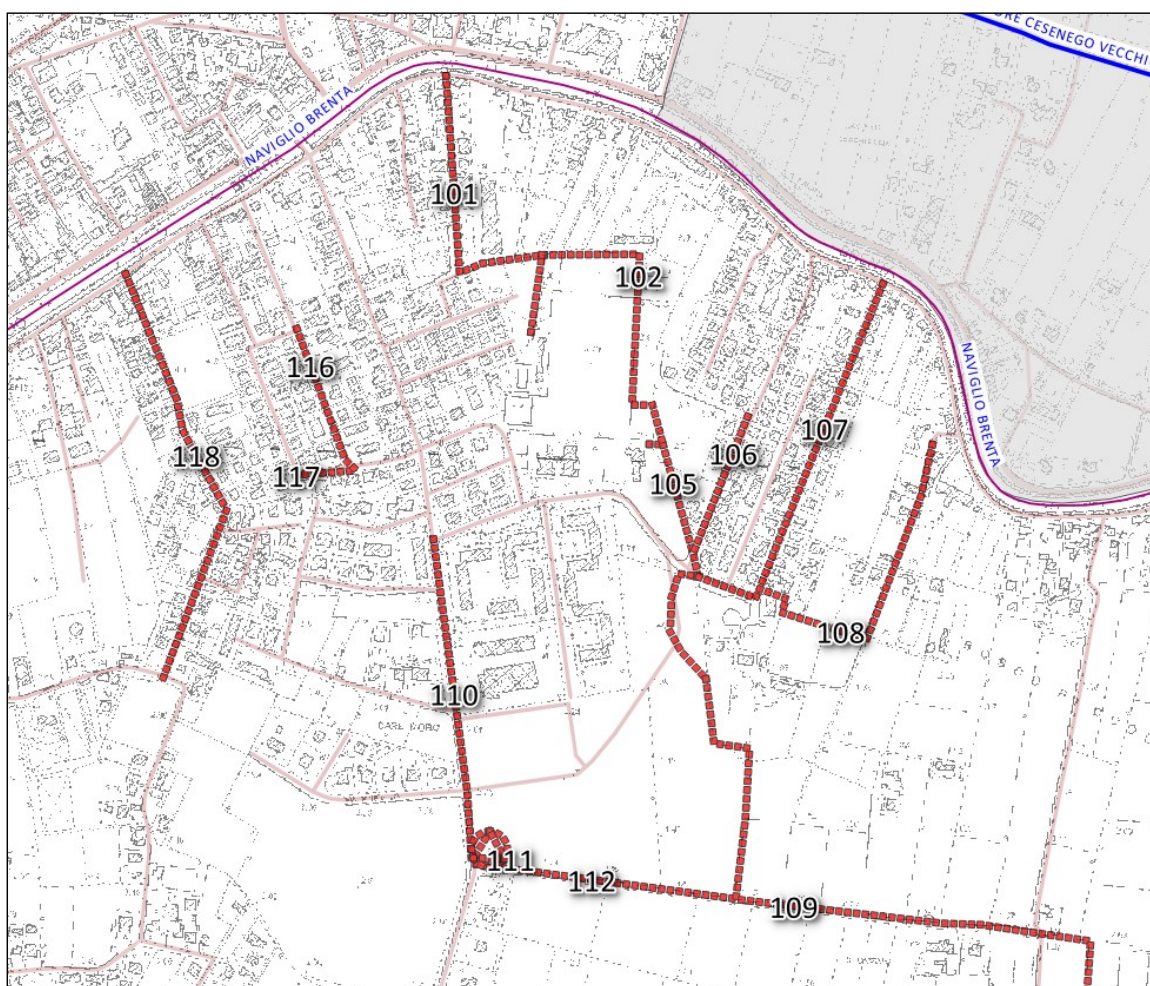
Individuazione interventi Oriago a sud del Naviglio, zona est
